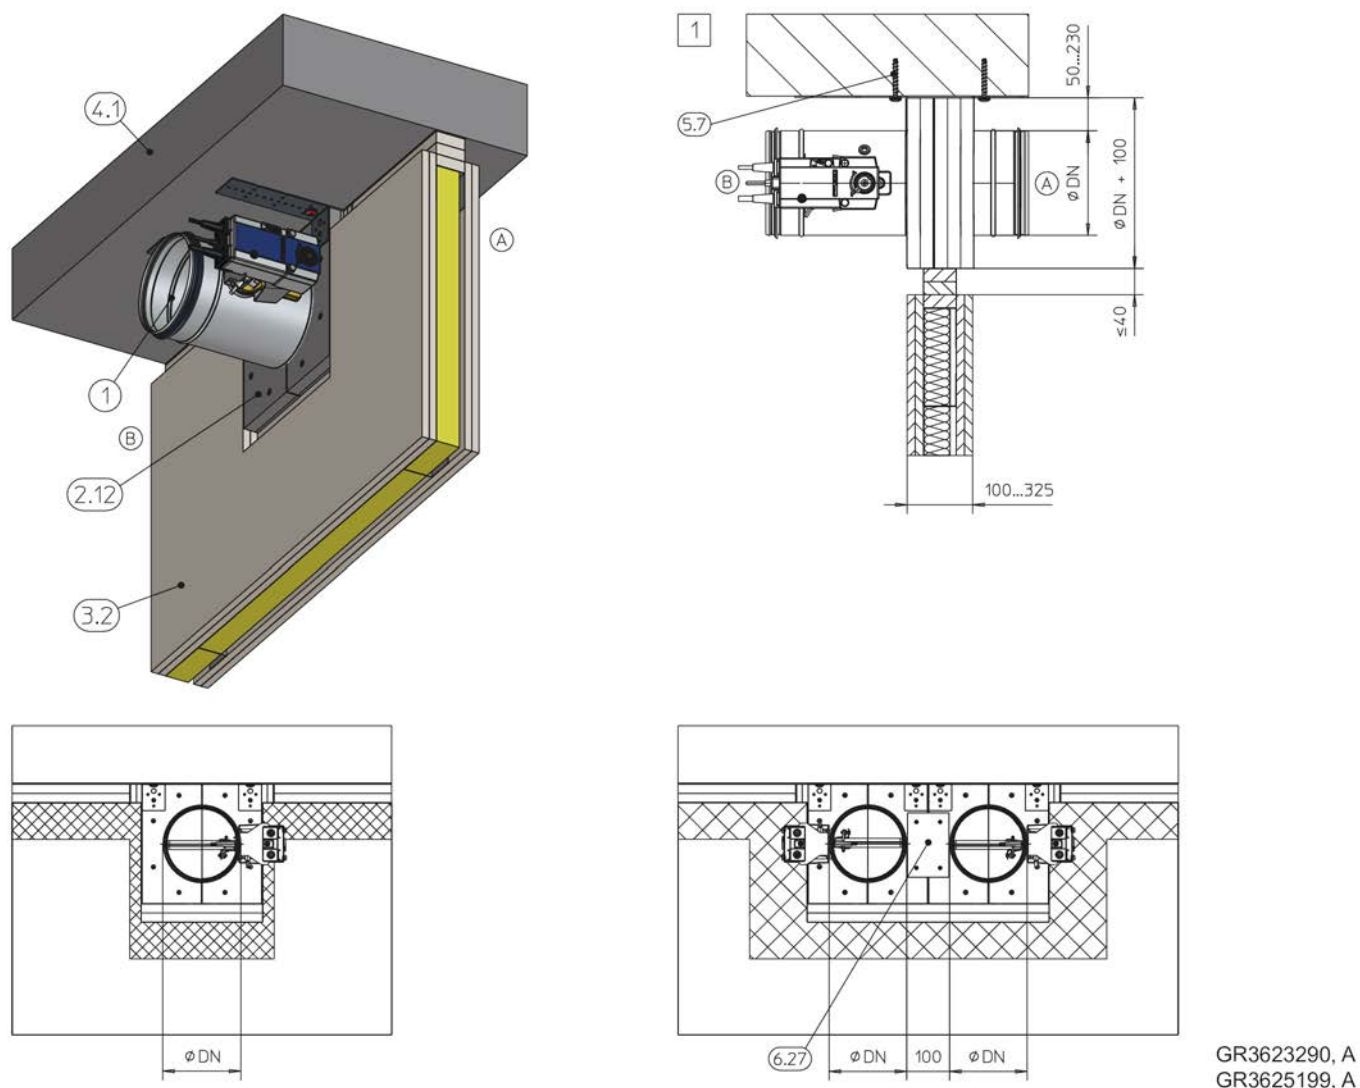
Монтаж без применения строительного раствора с монтажным комплектом GL / GL2 в легких перегородках или противопожарных перегородках
